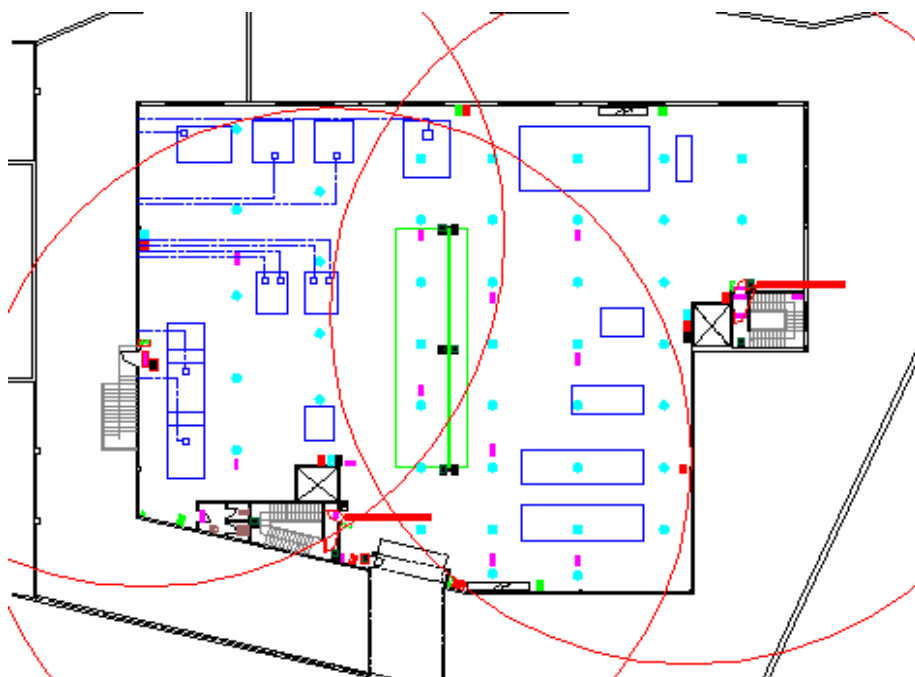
Superficie cubierta por las BIE's en la planta primera del edificio Almacén
